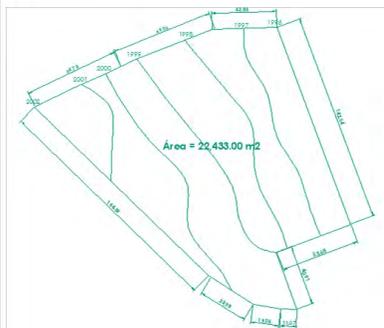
Plano topográfico (pendiente positiva del 2%)
